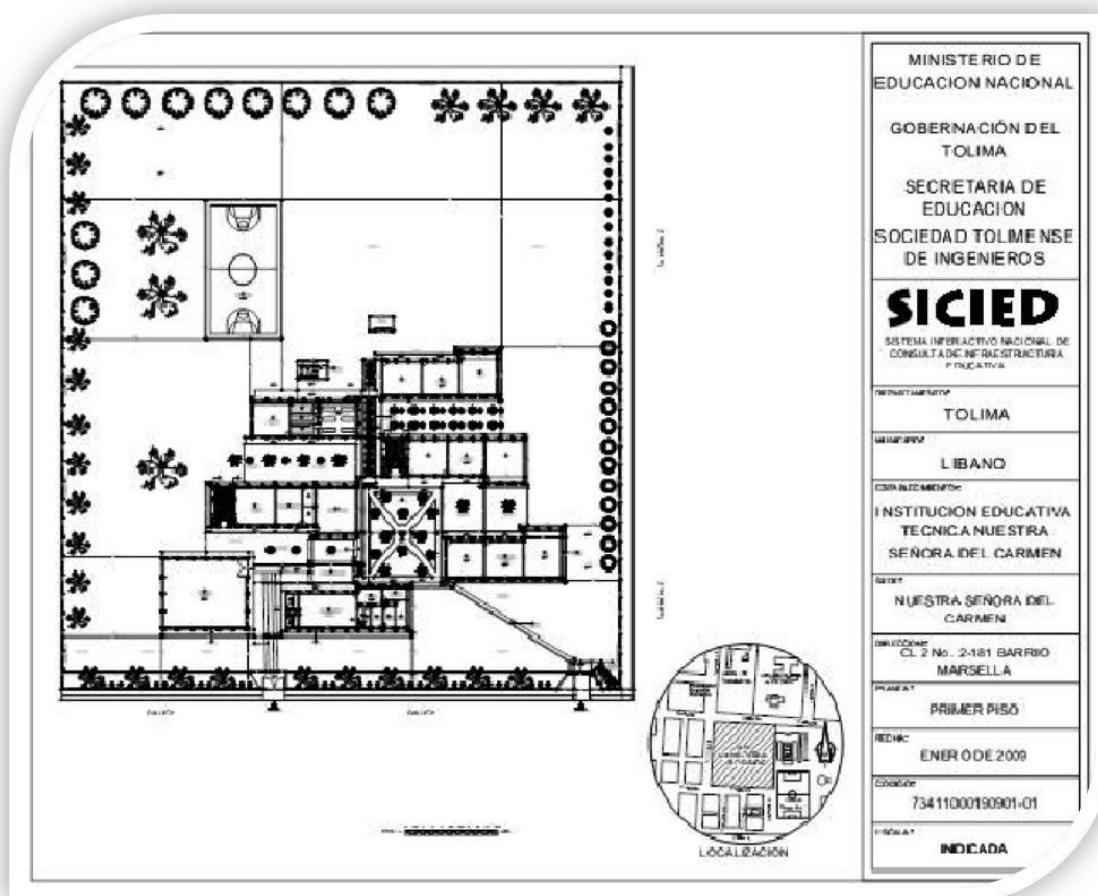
Plano I.E.T. Nuestra Señora del Carmen.
